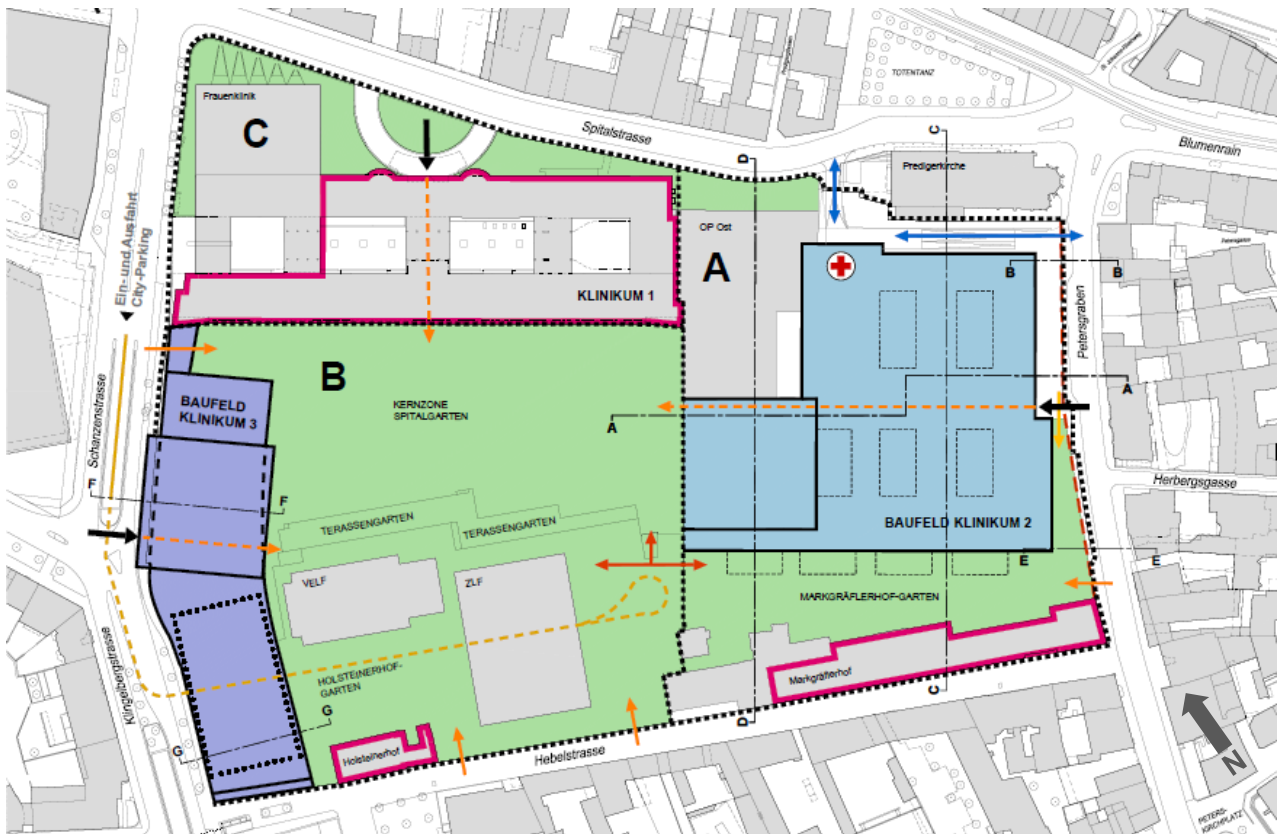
Bebauungsplan Nr. 13'778 (a): Änderung Bebauungsplan Nr. 215 (Situationsplan)
